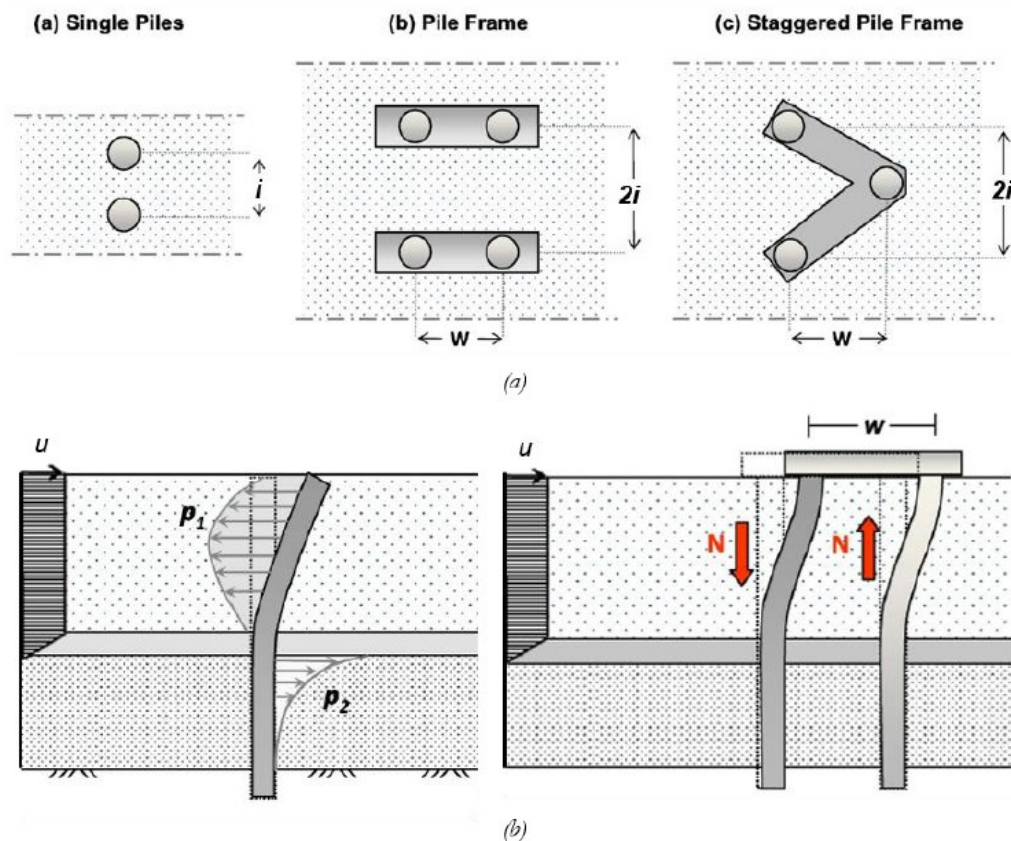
(a) Variazione della geometria della disposizione dei pali in pianta; (b) accoppiamento di pali tramite l'uso di una trave di collegamento in testa. (Kourkoulis et al., 2011)
